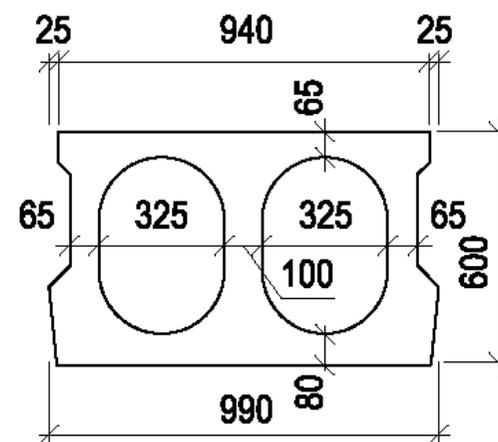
Поперечные сечения несущих конструкций пролетных строений
